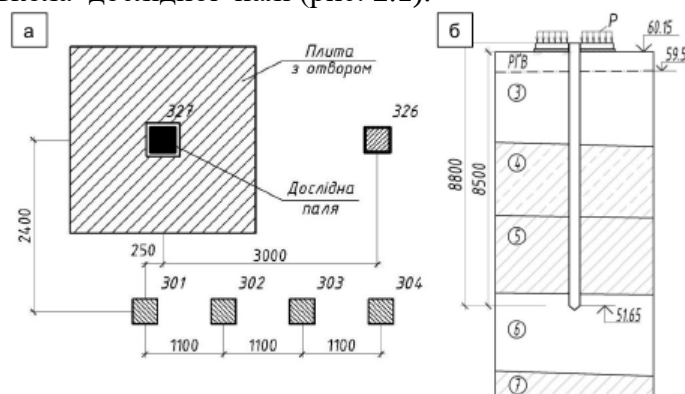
Схема розташування дослідних паль і фрагменту плити в плані (а) та розташування палі на інженерно-геологічному перерізі, розрахункова схема (б); P – навантаження на фрагмент плити з отвором
